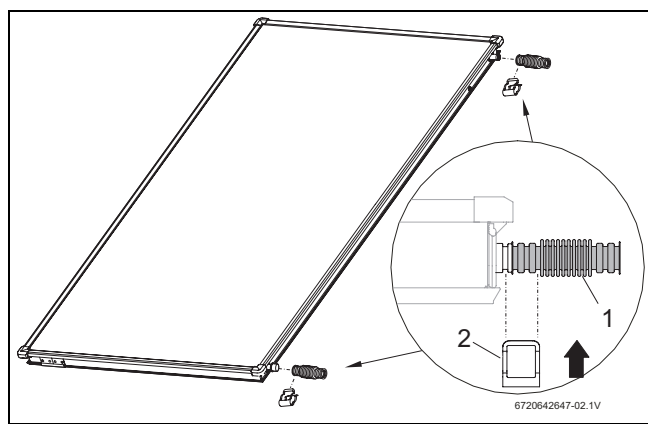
Pré-montar el juego de conexión en el segundo captador
